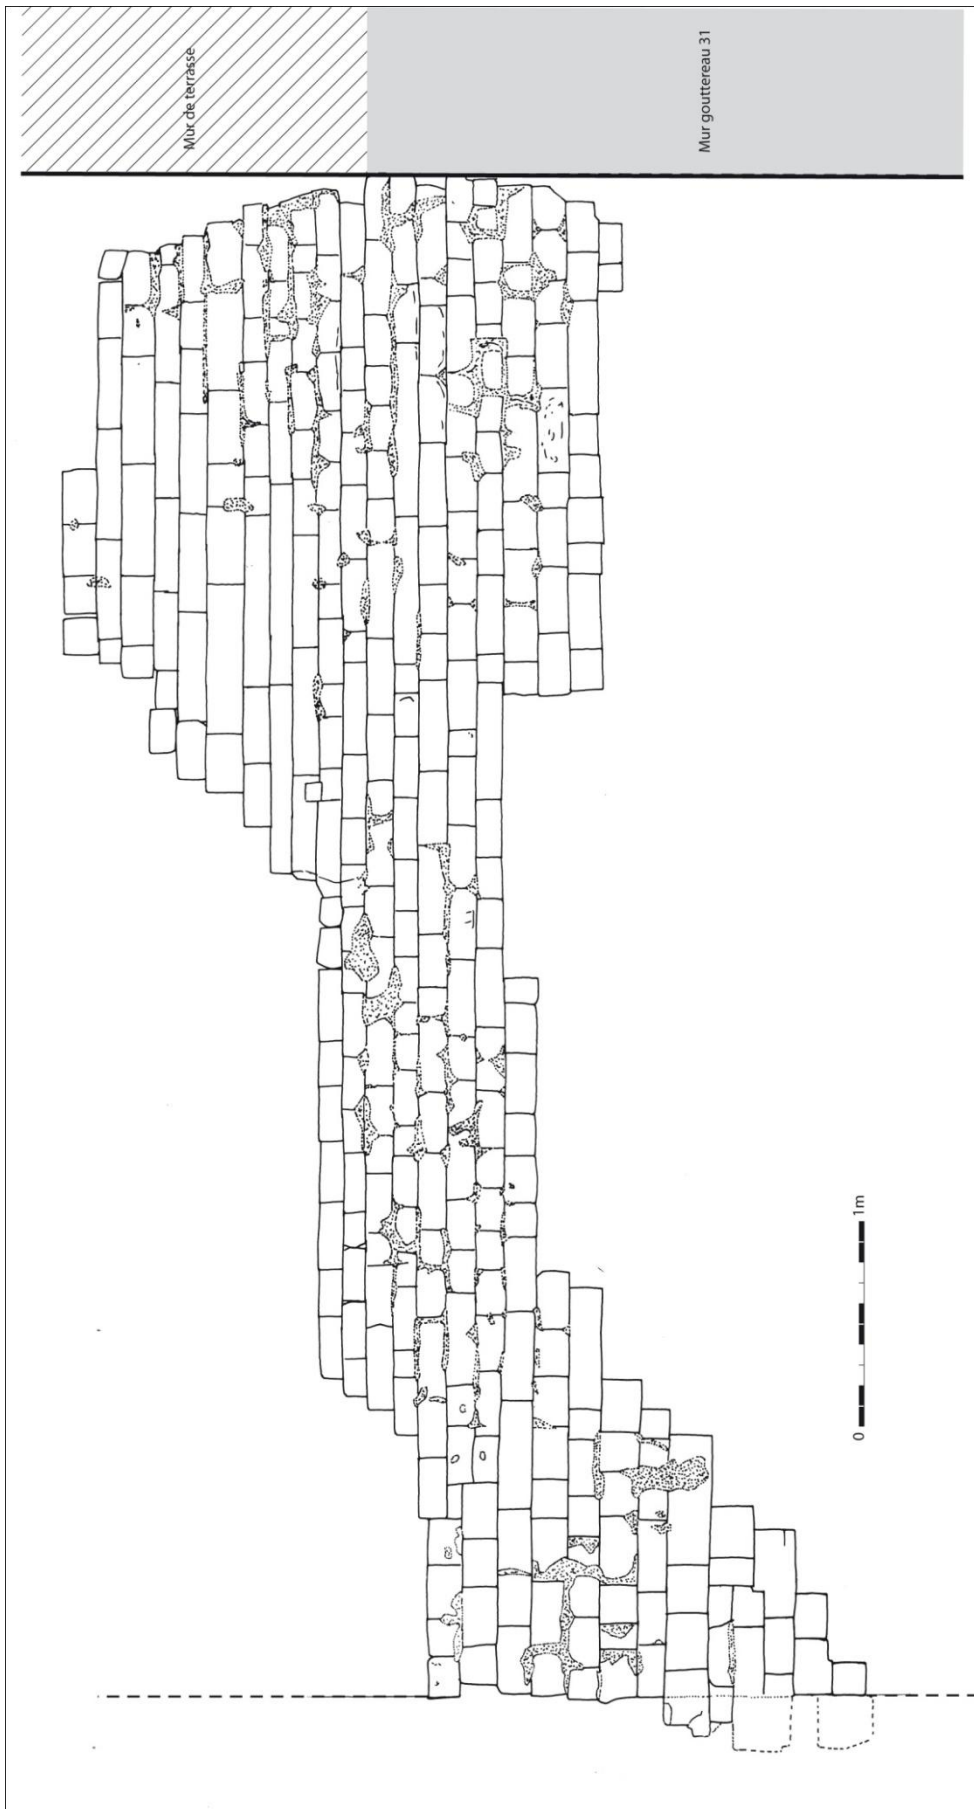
Relevé de la façade nord du mur de façade (relevé et D.A.O. : M. Varano).
